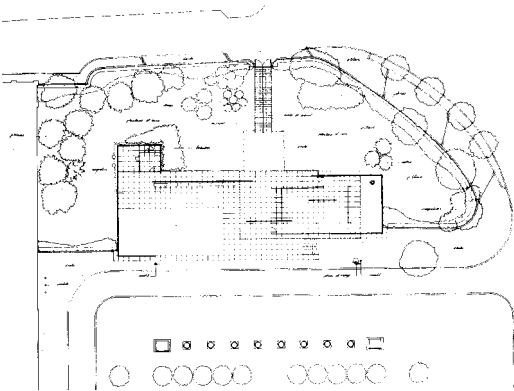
Grundriß des Pavillons des Deutschen Reiches.
